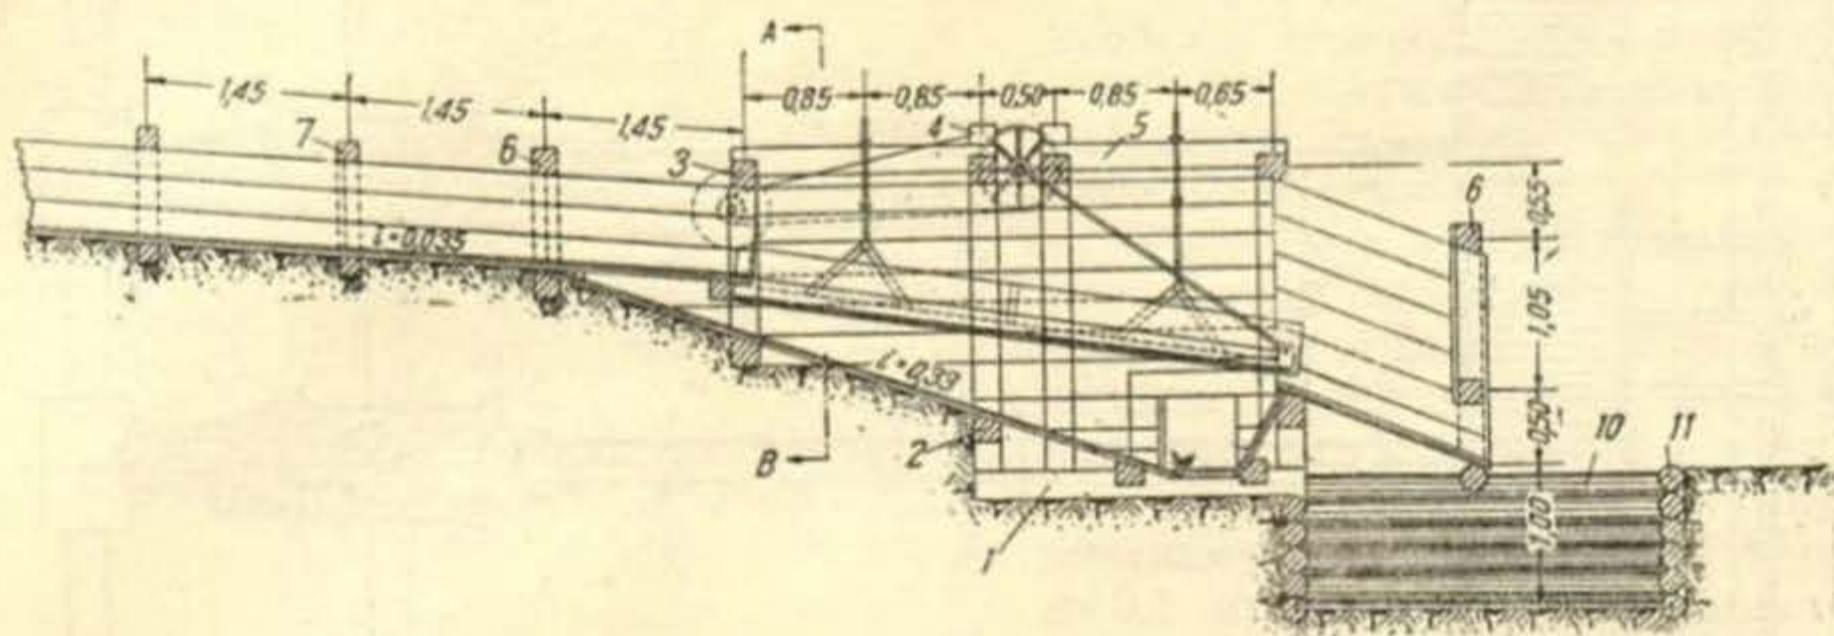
в. Типовая установка неподвижного грохота (grizzle). Разрез по C — D
